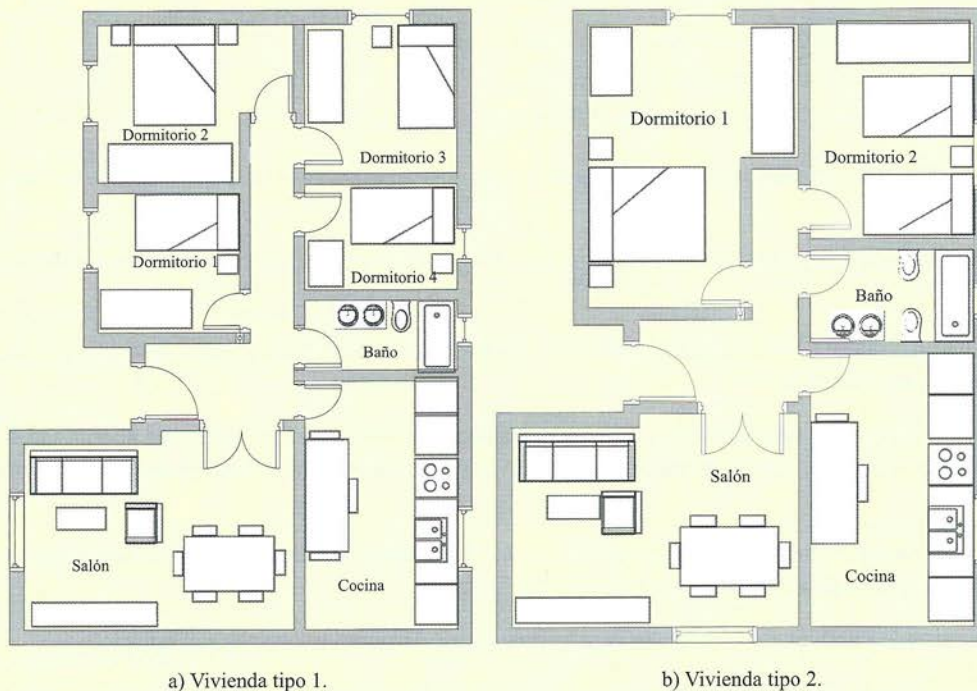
Planta tipo de las viviendas del edificio bajo estudio.
